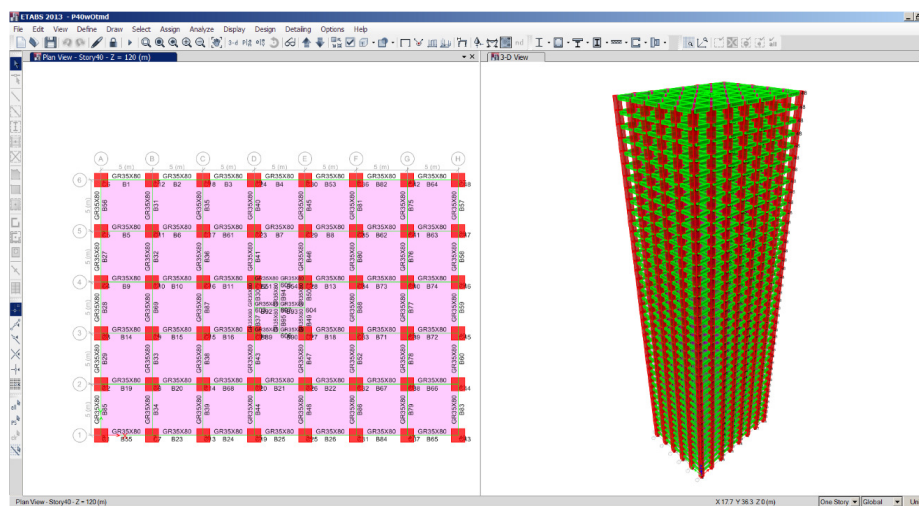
Structura in cadre cu forma dreptunghiulara P+40E- plan si elevatie
